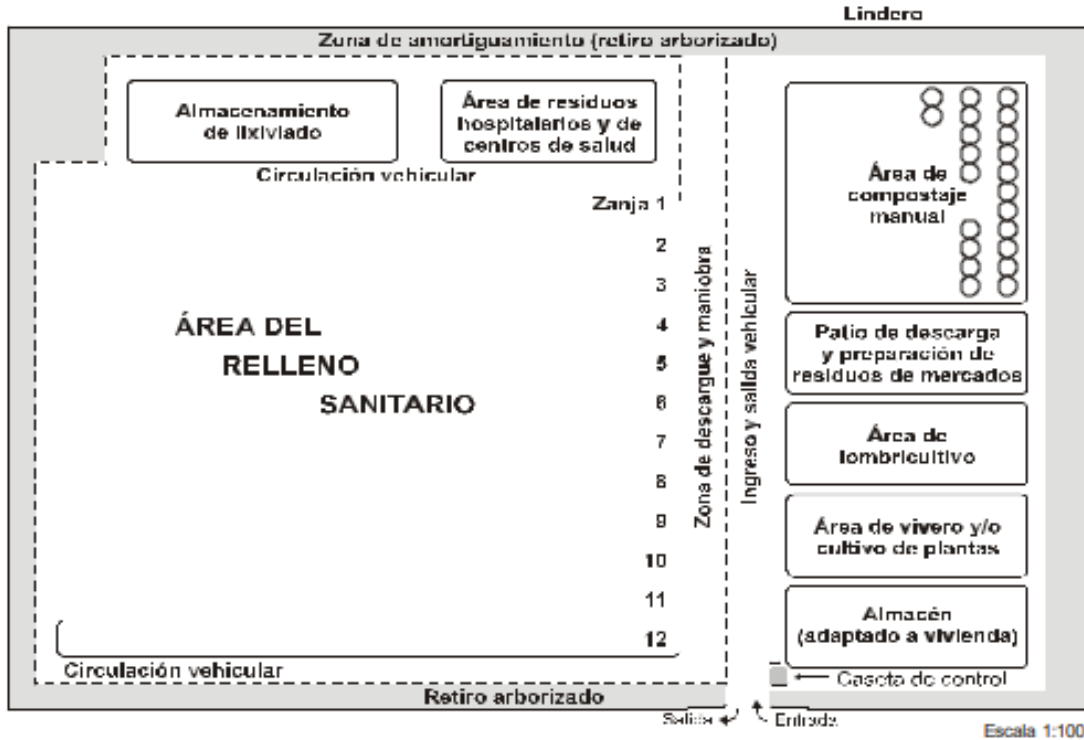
Vista en planta de un sistema integrado de tratamiento y disposición final de RSM
